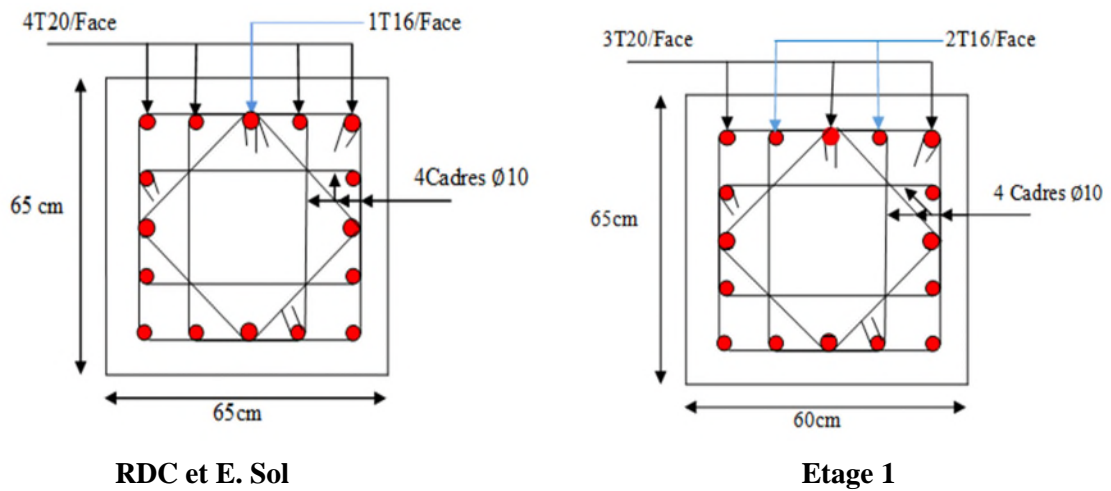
Schéma de ferrailage des poteaux du RDC, E. Sol et étage 1
